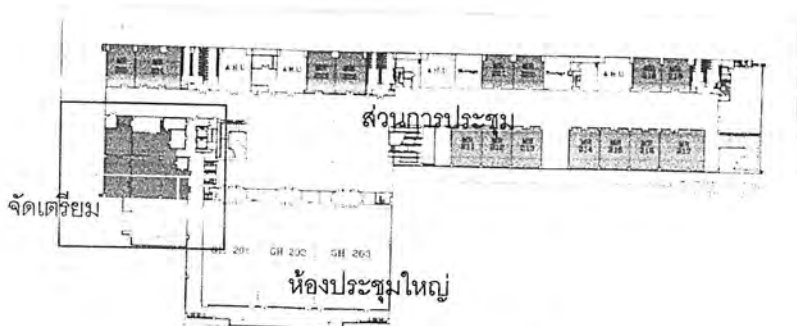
แสดงผังพื้นที่ใต้ดิน
